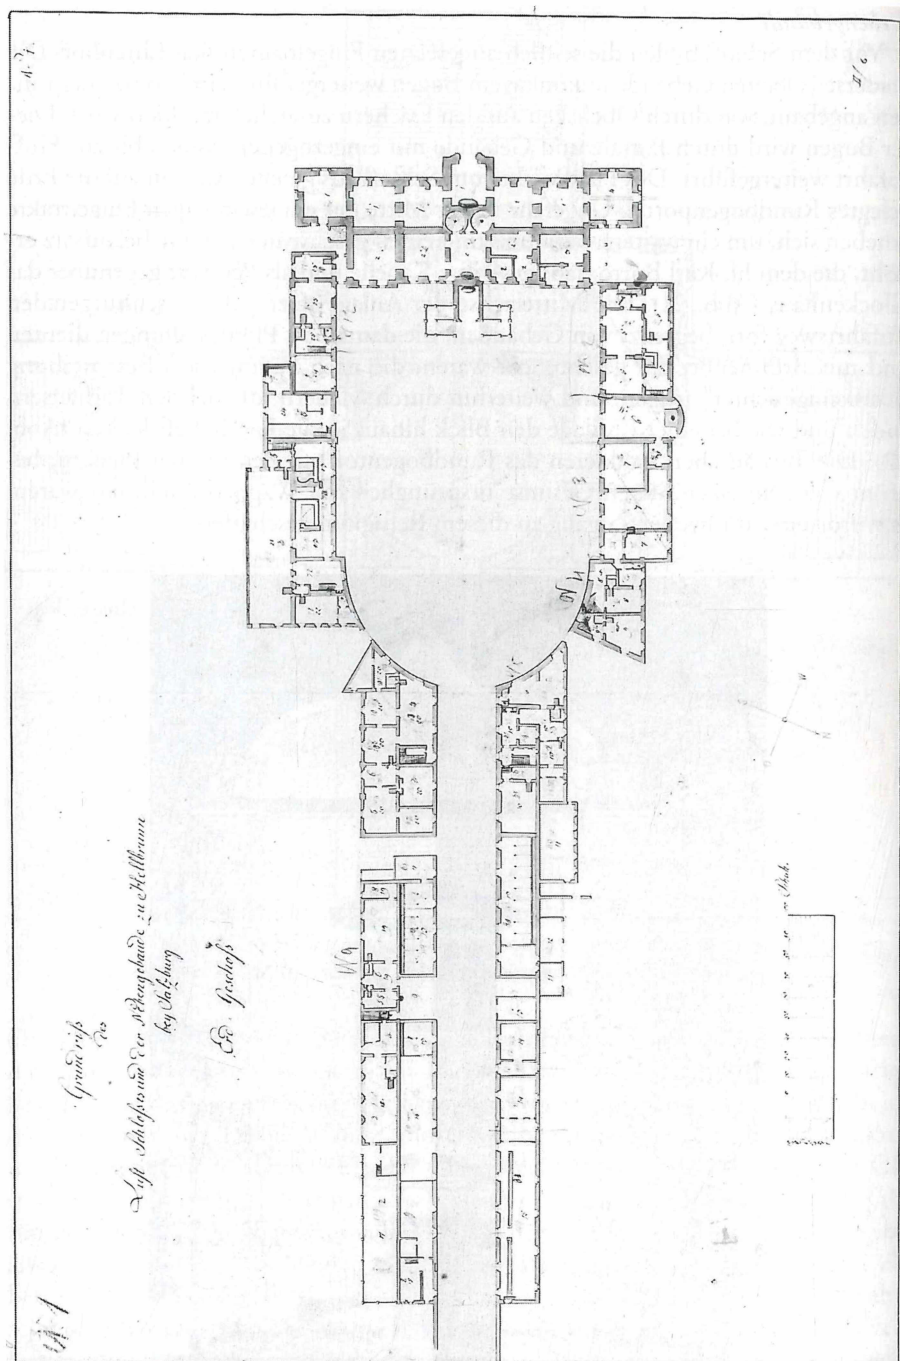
Salzburg: Schloß Hellbrunn, Grundriß. Planzeichnung von Louis Grenier; SLA, BA VI, 4.5.
